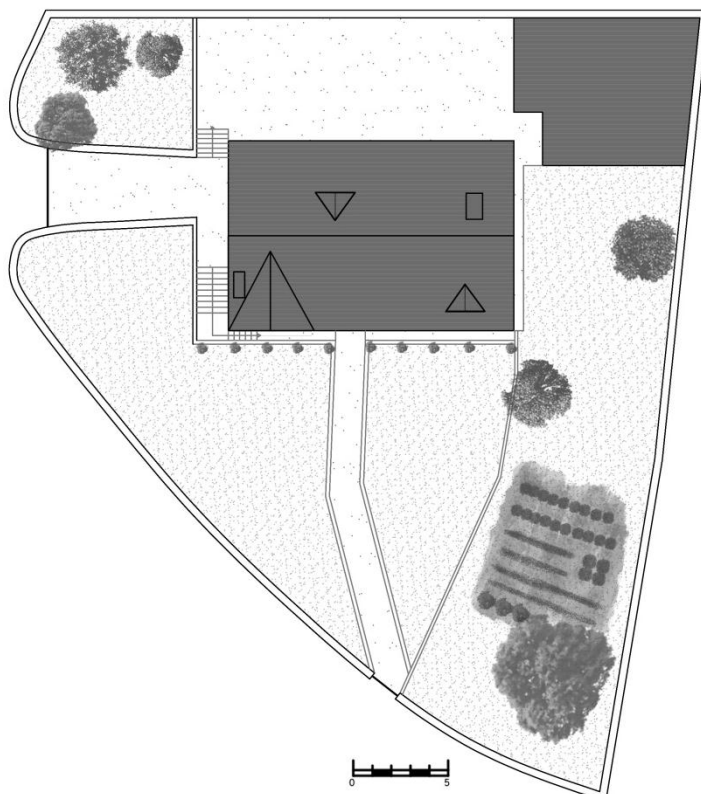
Planta de cobertura da casa de Francisco¹⁸
